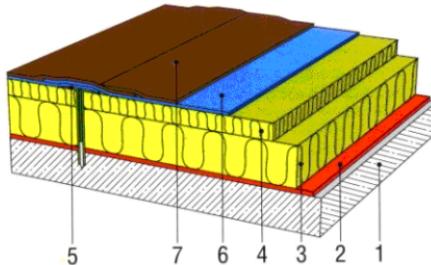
Двухслойное теплоизоляционное решение кровли с двухслойным наплавляемым гидроизоляционным ковром и механическим креплением: 1 — несущая железобетонная плита покрытия; 2 — пароизоляционный слой из плит РУФ БАТТС Н; 4 — теплоизоляционный слой из плит РУФ БАТТС В; 5 — механическое крепление (металлический дюбель); 6 — нижний слой наплавляемого гидроизоляционного ковра; 7 — верхний наплавляемый гидроизоляционный ковер
